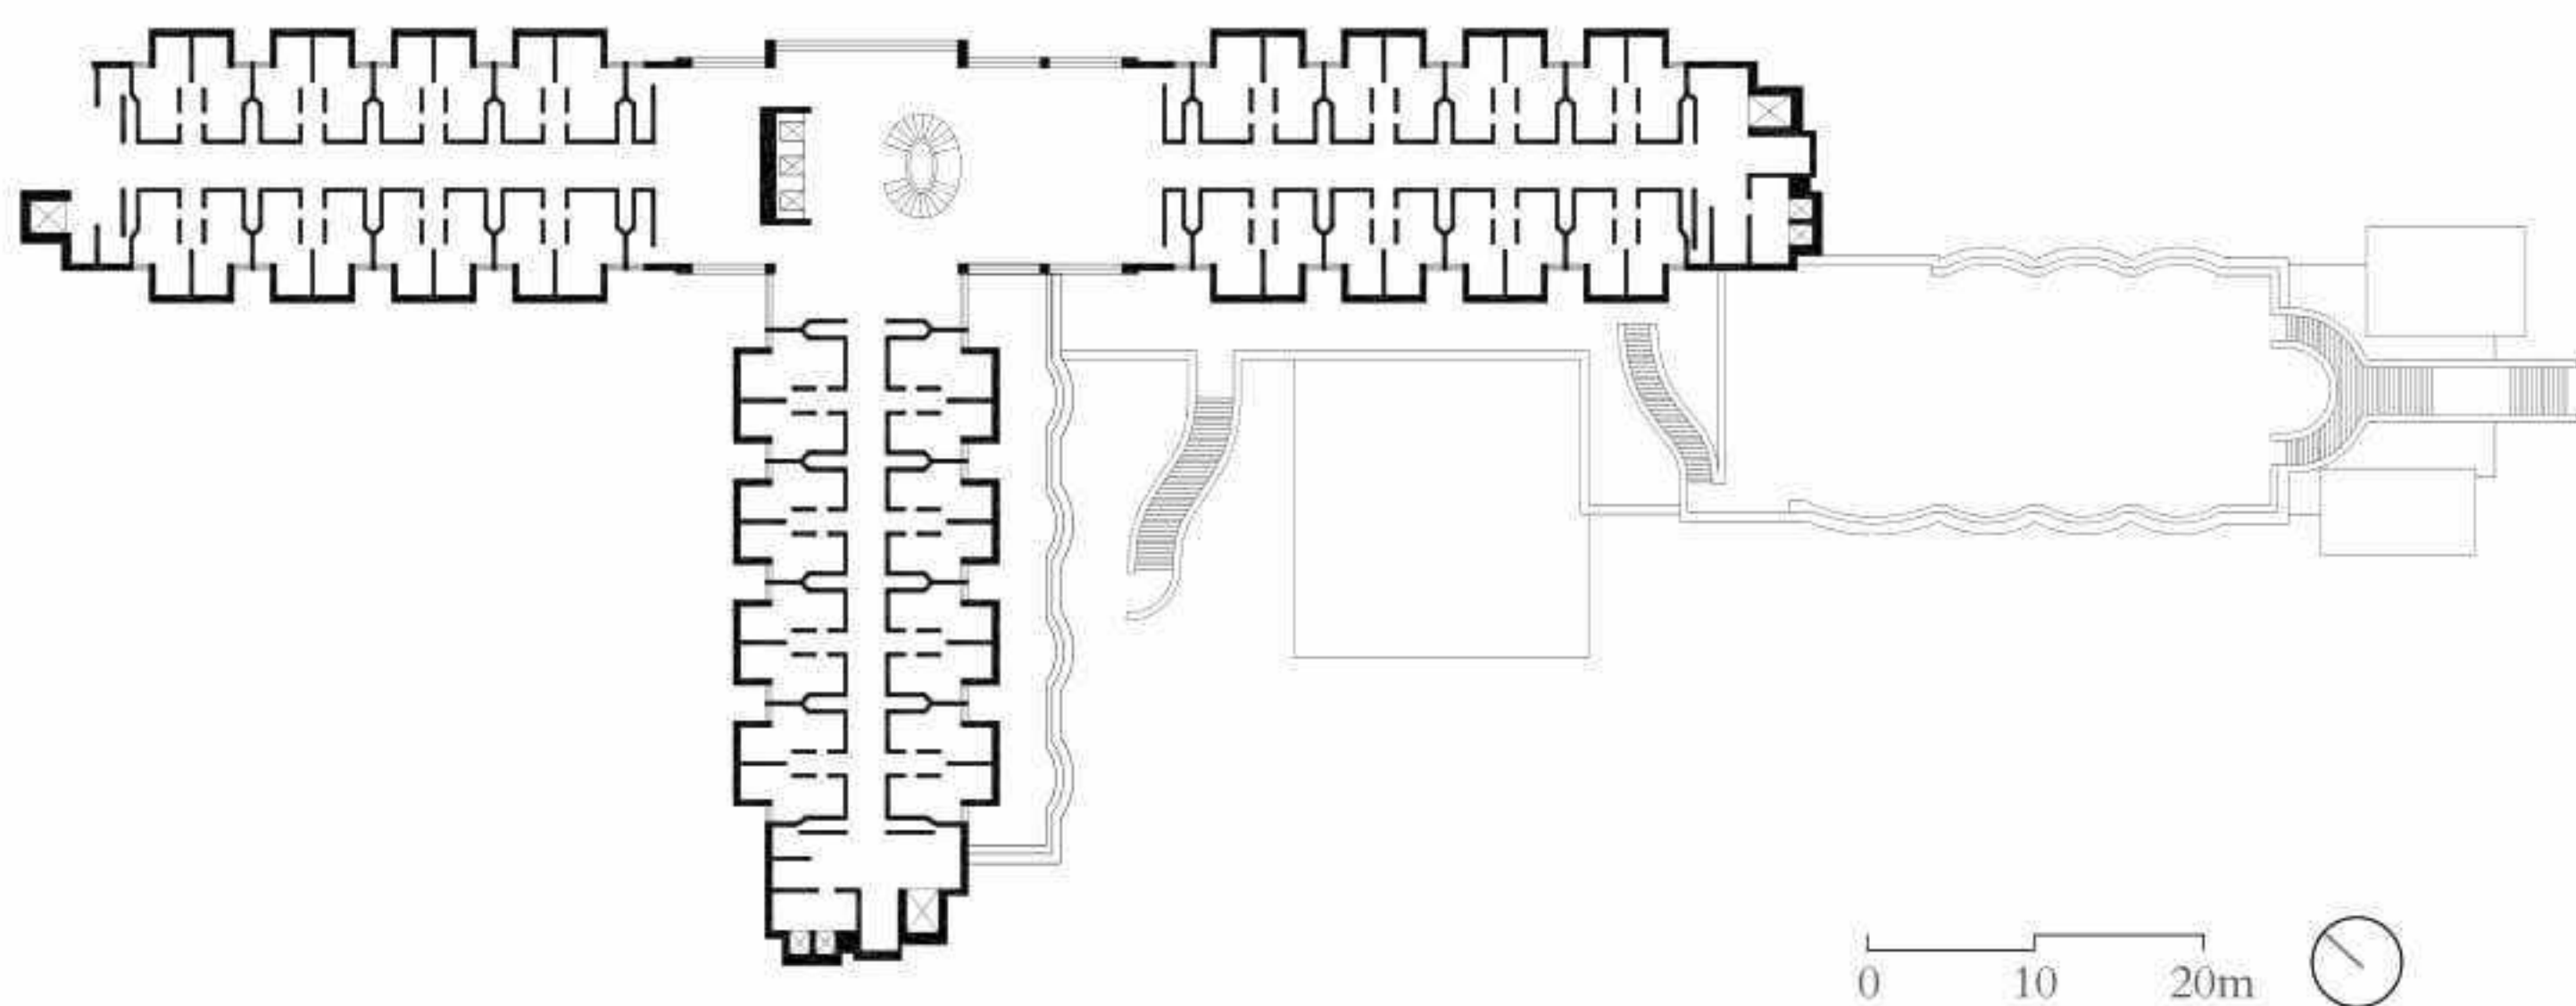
Stabilimento termale Zoja*, pianta piano tipo.
